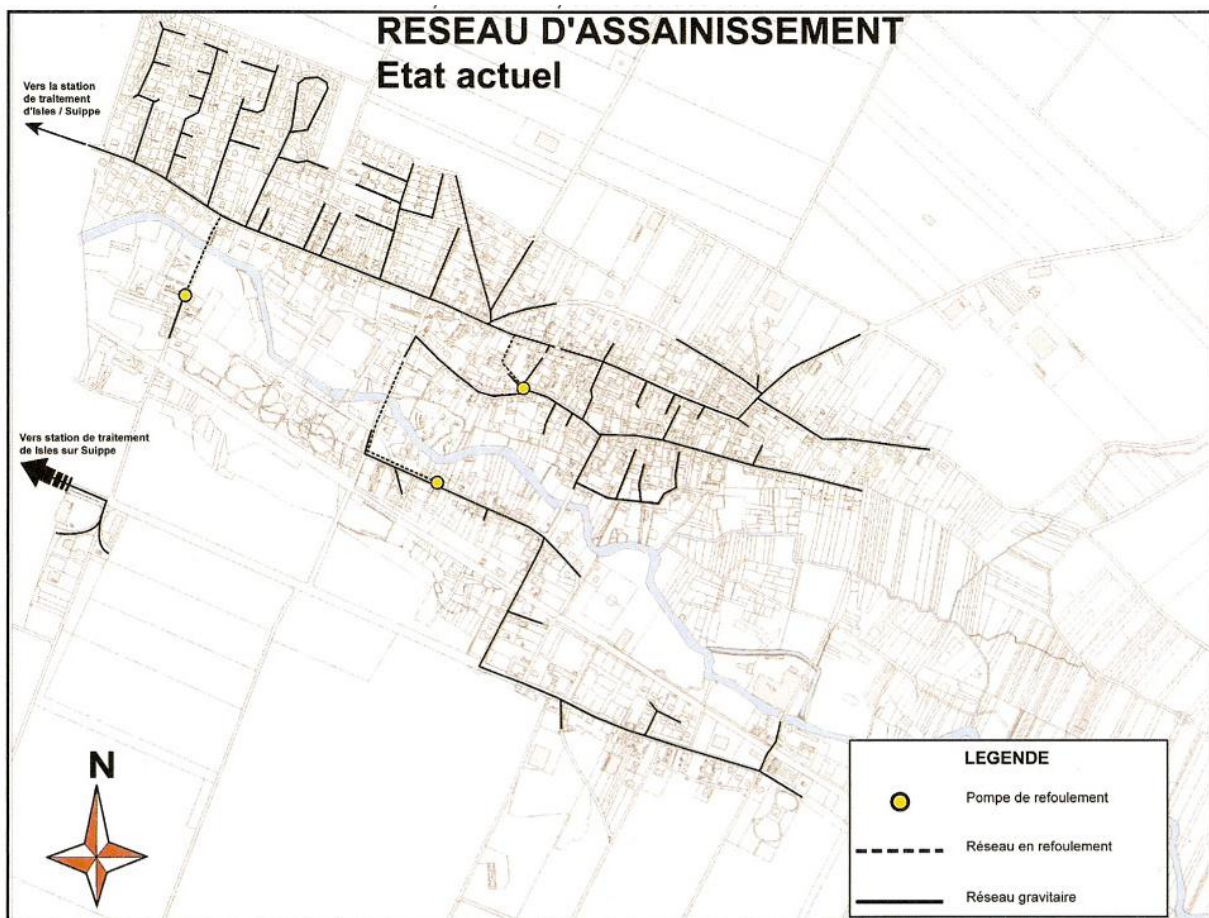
réseau d'assainissement (source : PLU de Warmeriville)
